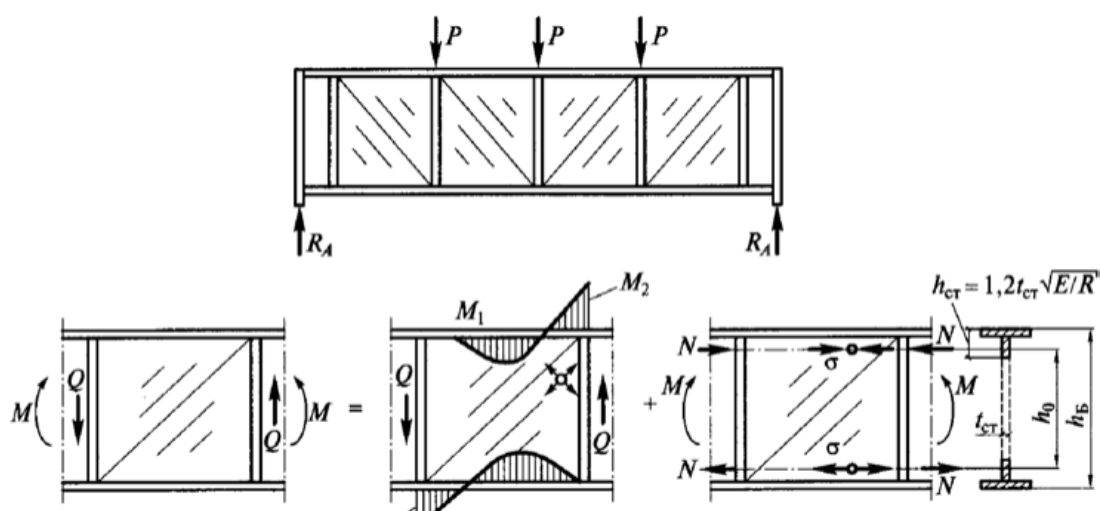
Балка с гибкой стенкой, схема работы и эпюры внутренних усилий
